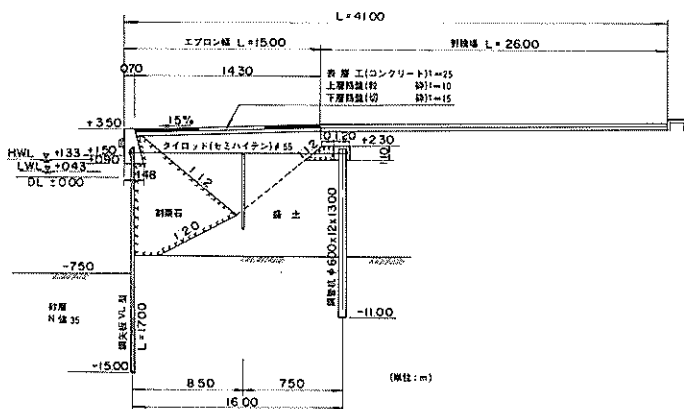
相馬港-7.5m岸壁(A断面, 取付部)標準断面図
